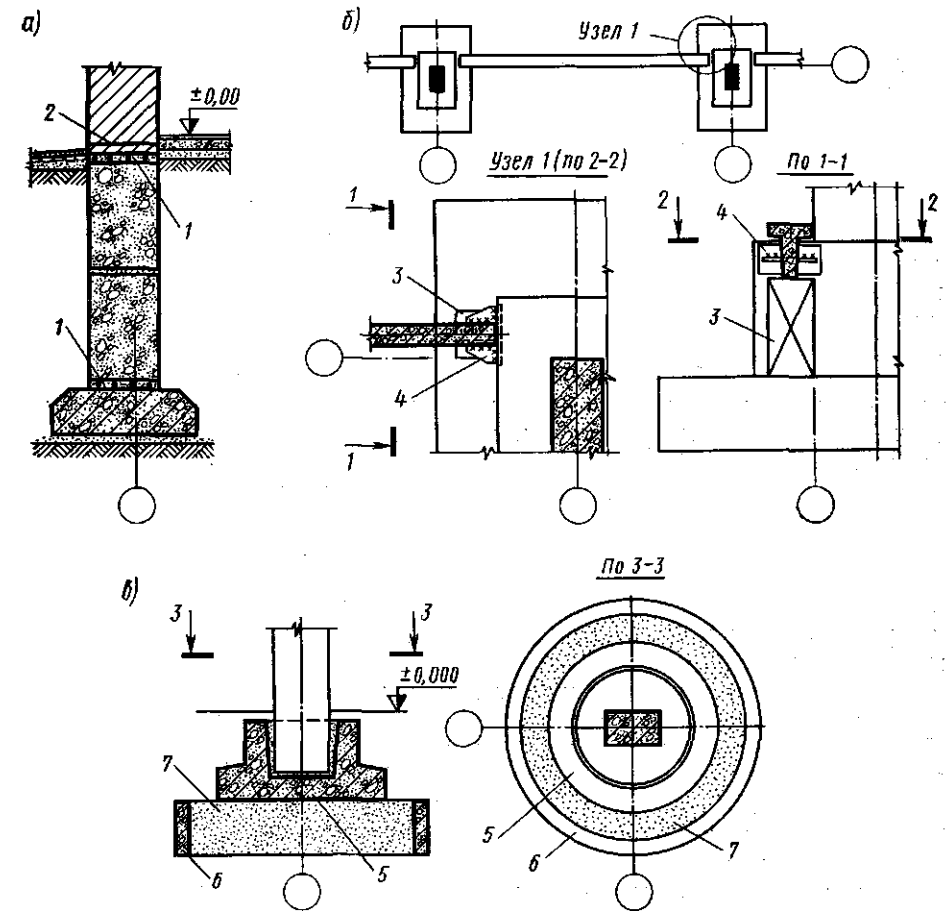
Фундаменты сейсмостойких зданий:
